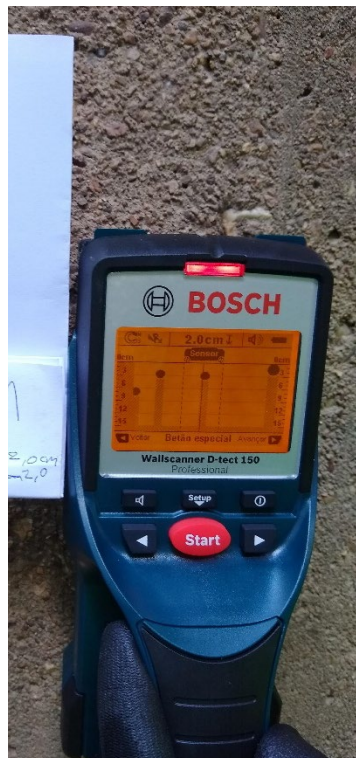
leitura do cobrimento de concreto P1-F1=2,0cm
